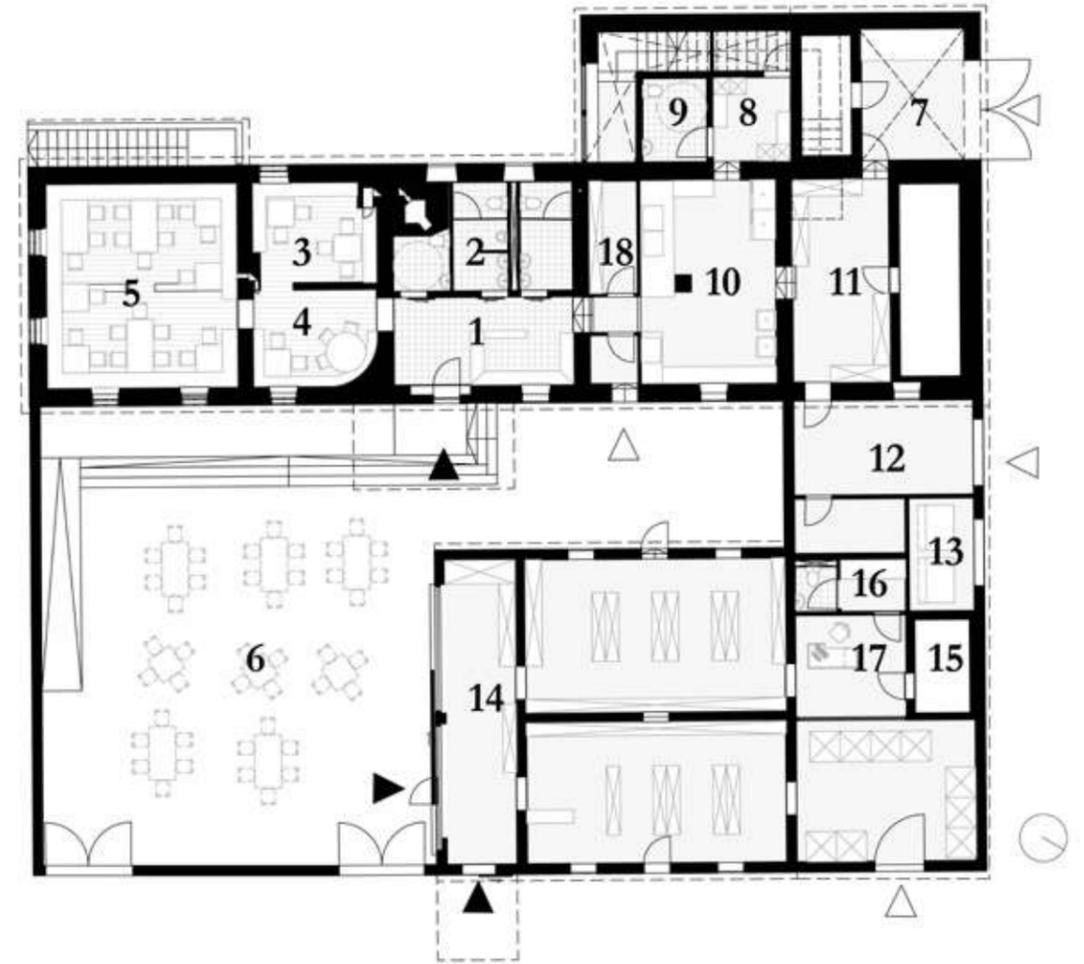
Grundriss Erdgeschoss, M 1:200
